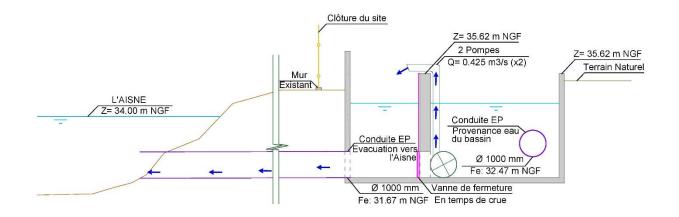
Vue en plan et coupe de la station de pompage de SANOFI
